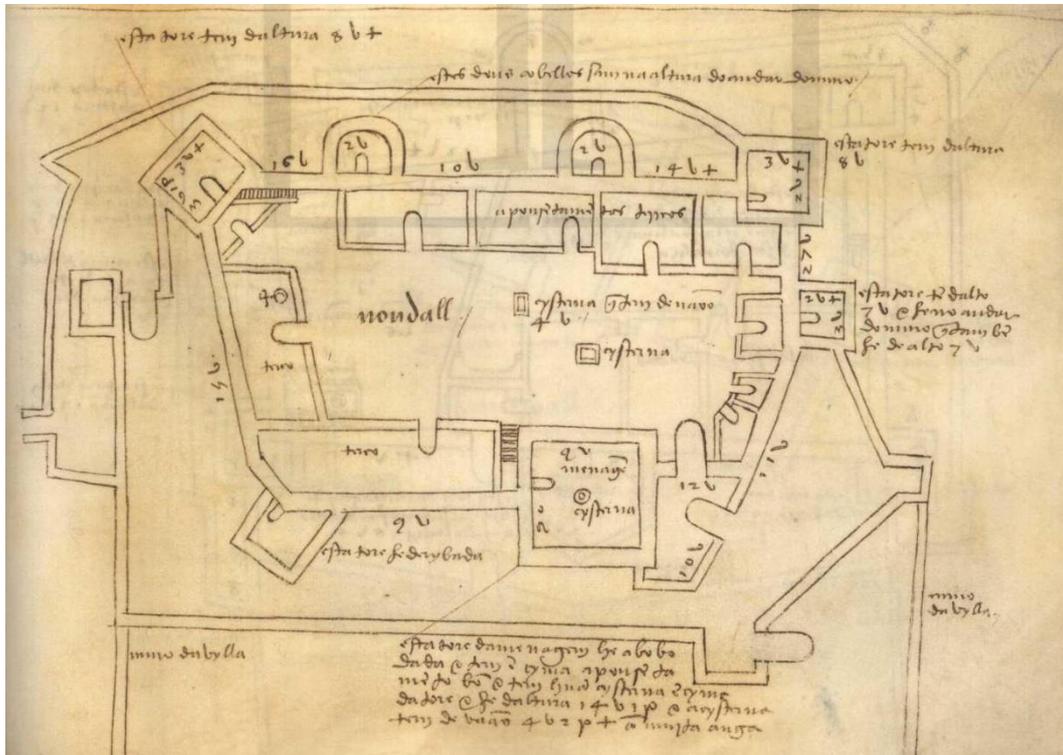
Planta do Castelo de Noudar, anterior à construção do aposentamento sobradado.
